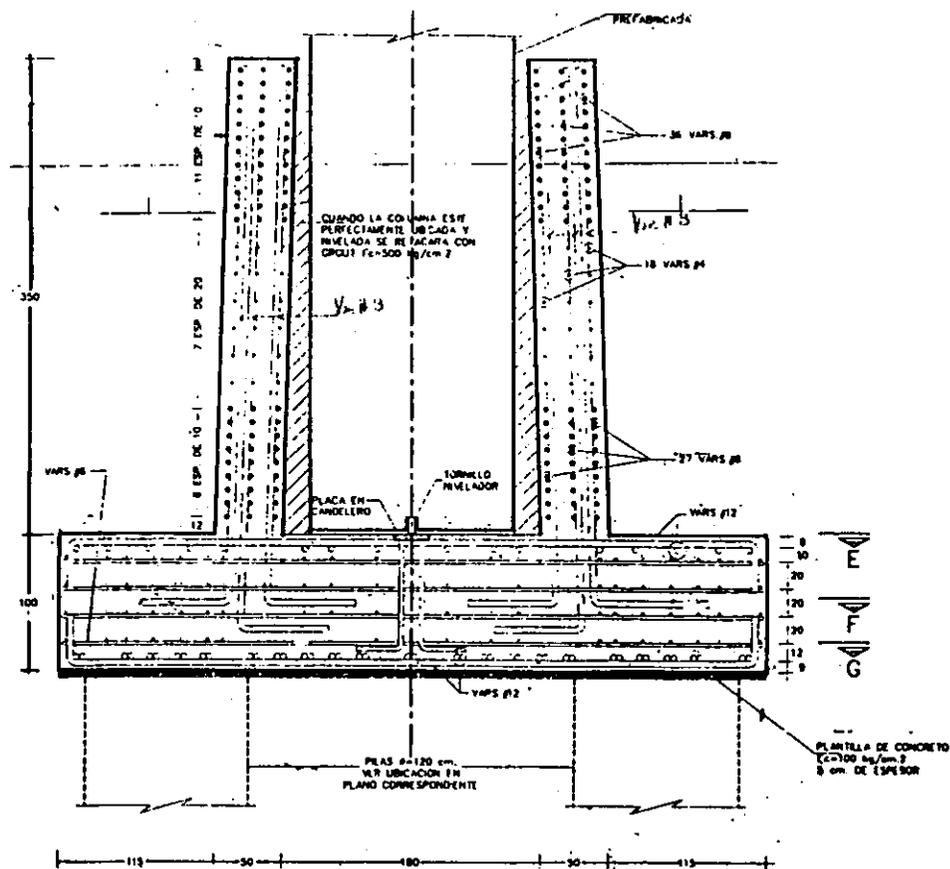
C(2). Corte Transversal de zapata de Cimentación (lado corto).
